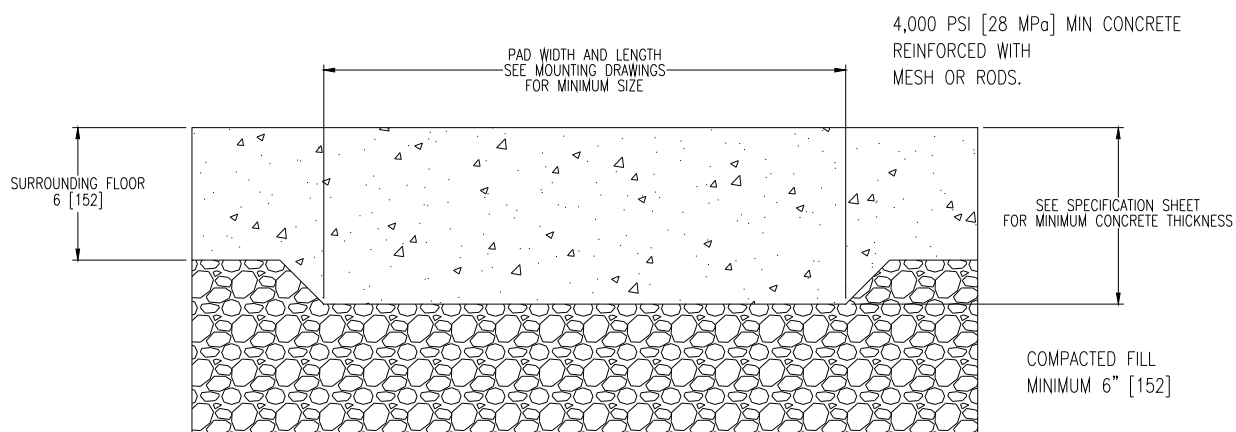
Installazione della lavatrice su pavimento nuovo
